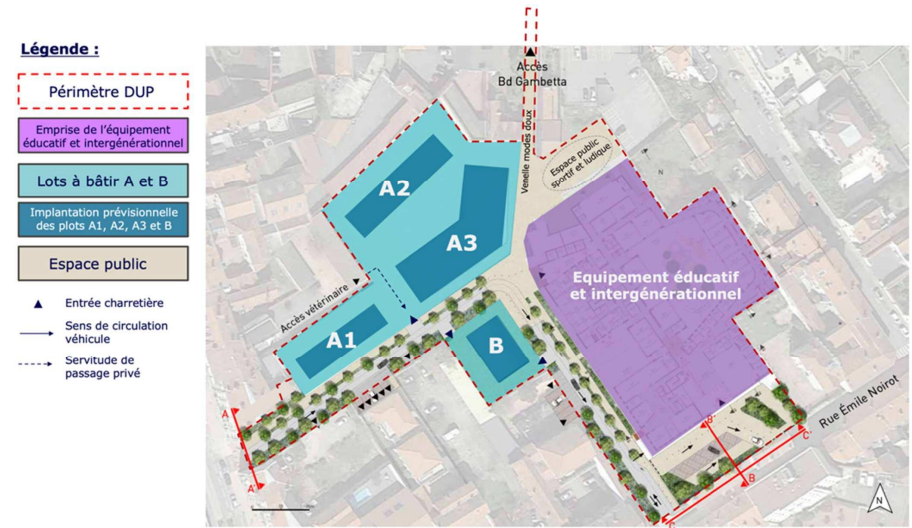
Plan d'ensemble du projet de ZAC (Ville de Roanne)
